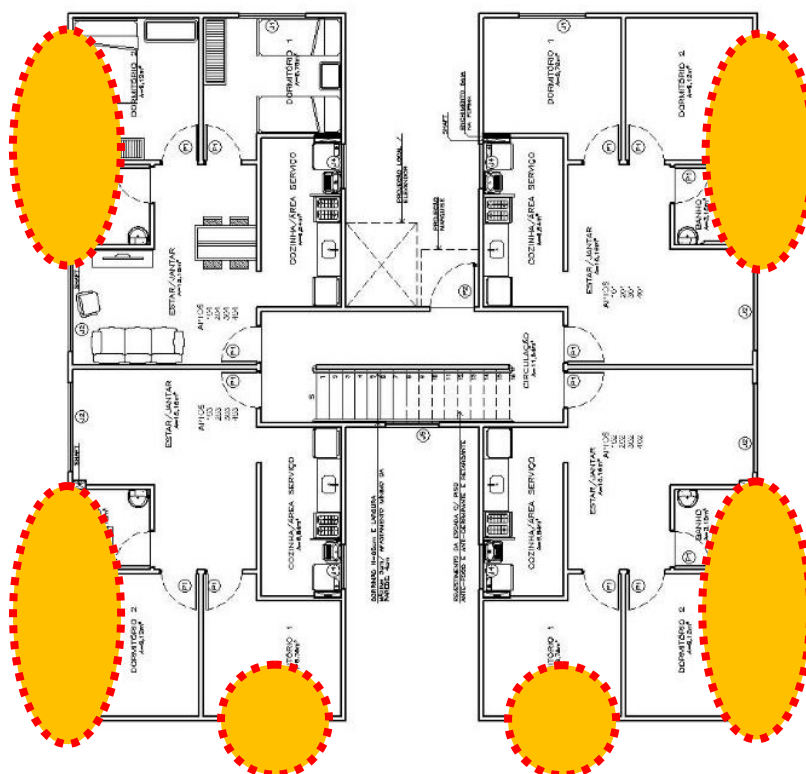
Planta baixa do pavimento tipo do Residencial Tocantins. Fonte: Planta baixa do pavimento térreo do Empreendimento Tocantins 1, SEPLAN nº 4620/2014.
